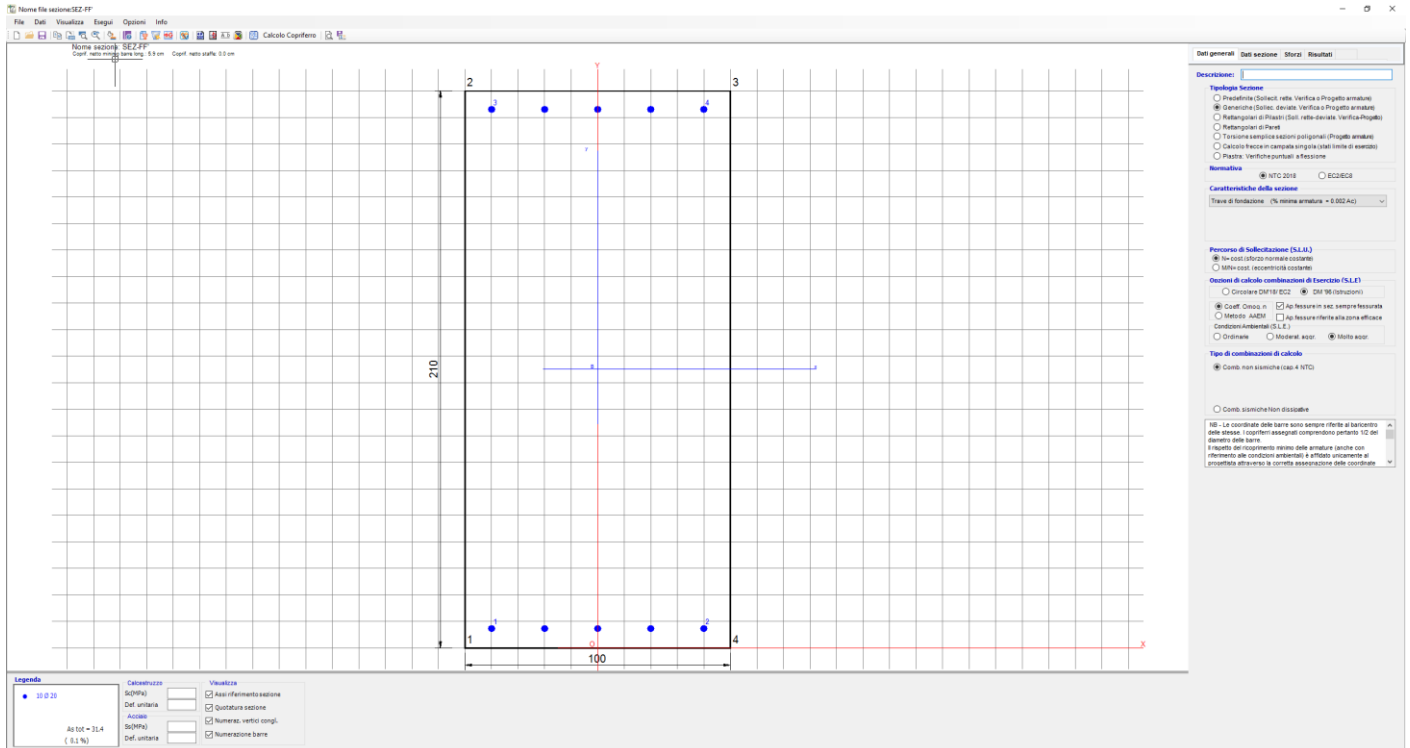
Muro frontale - Geometria sezione di verifica
